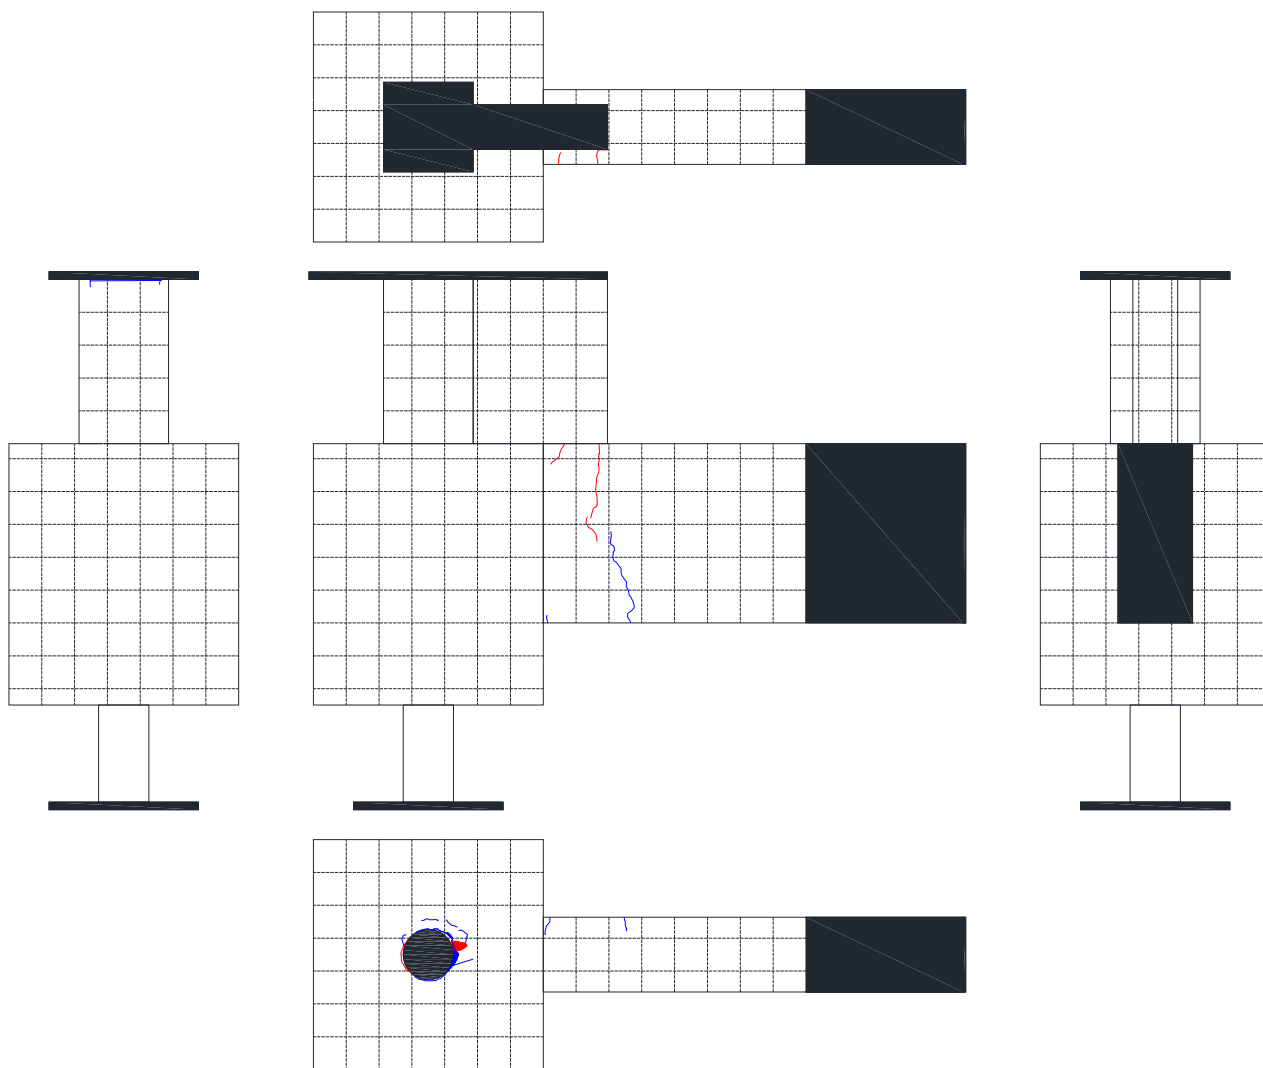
3. 4-8 ひび割れ状況 (R=±2. 0%サイクル②)
